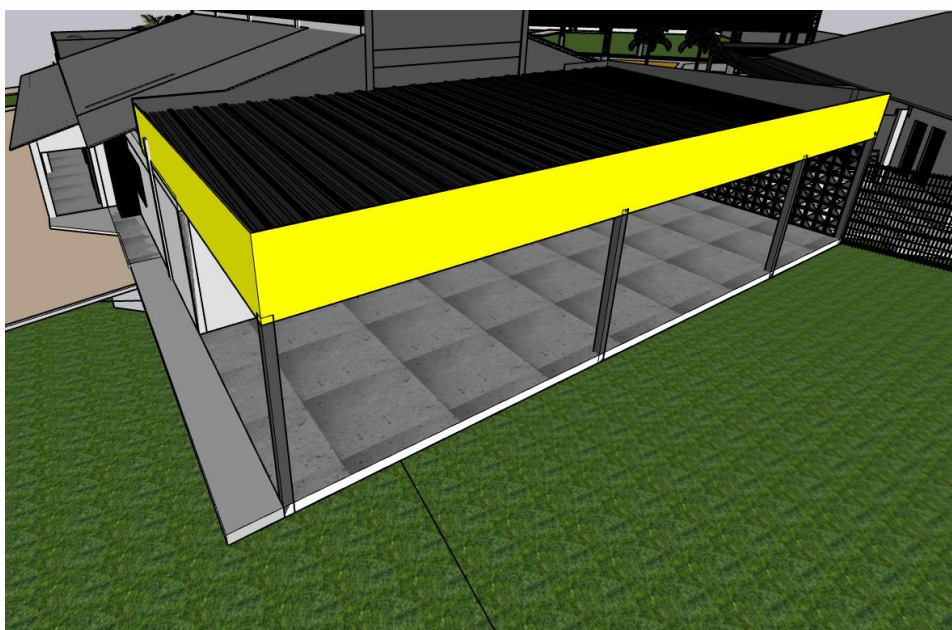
Cobertura posterior – em estrutura metálica com fechamento em glasroc, telha termoacústica com acabamento na parte inferior e forro de gesso acartonado.
